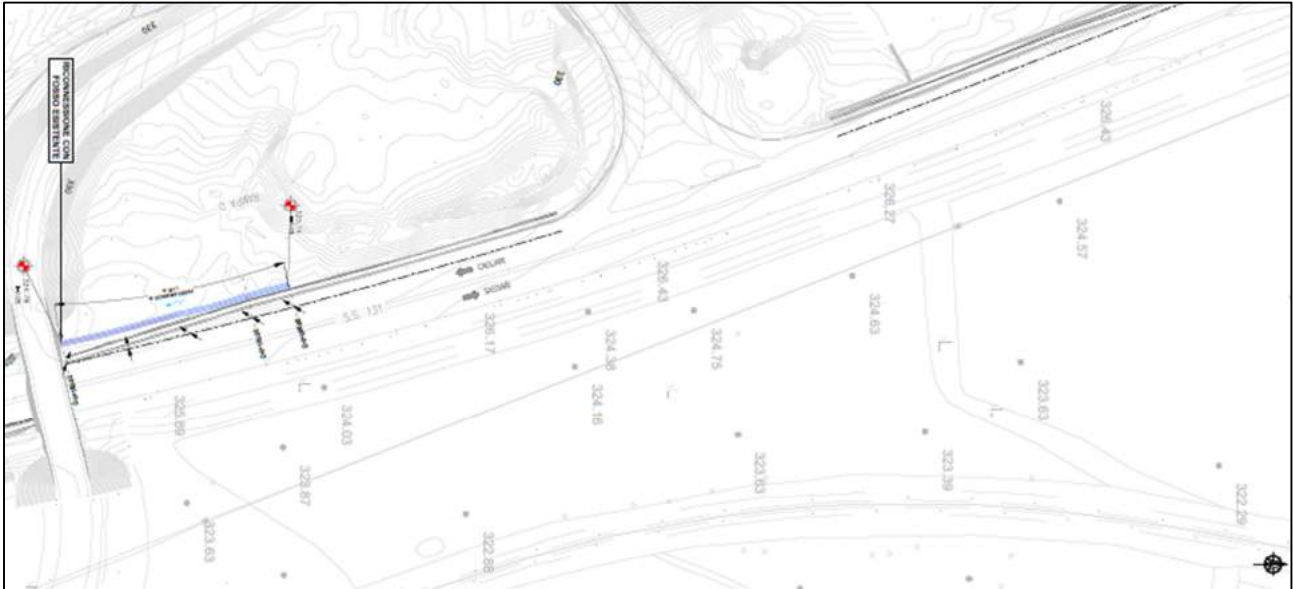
Stralcio planimetrico intervento V07-Svincolo di Norbello al km 128+000
